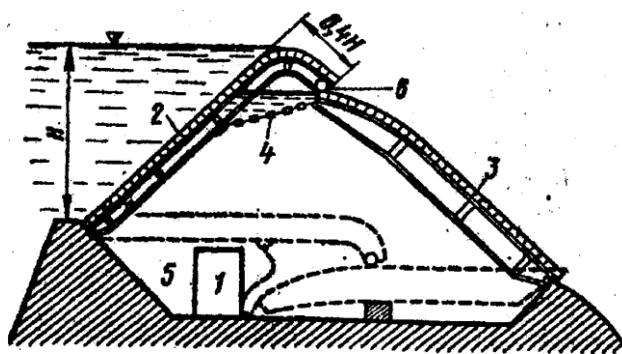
Крышевидный затвор: 1 - водовод в устье; 2 и 3 - верхнее и нижнее полотнища; 4 - ограничитель; 5 - камера; 6 - ролик.
